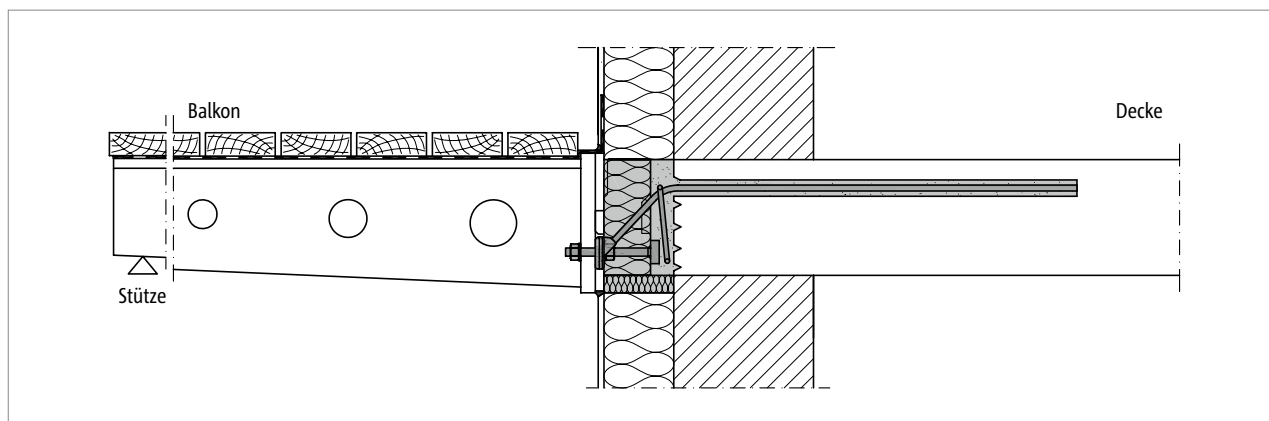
Schöck Isokorb® RT Typ SQ: Balkon mit Stützenlagerung bei Erneuerung eines Bestandsbalkons
